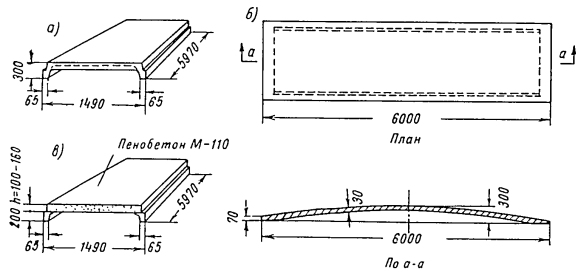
Типовые конструкции для покрытия кровель одноэтажных промышленных зданий
